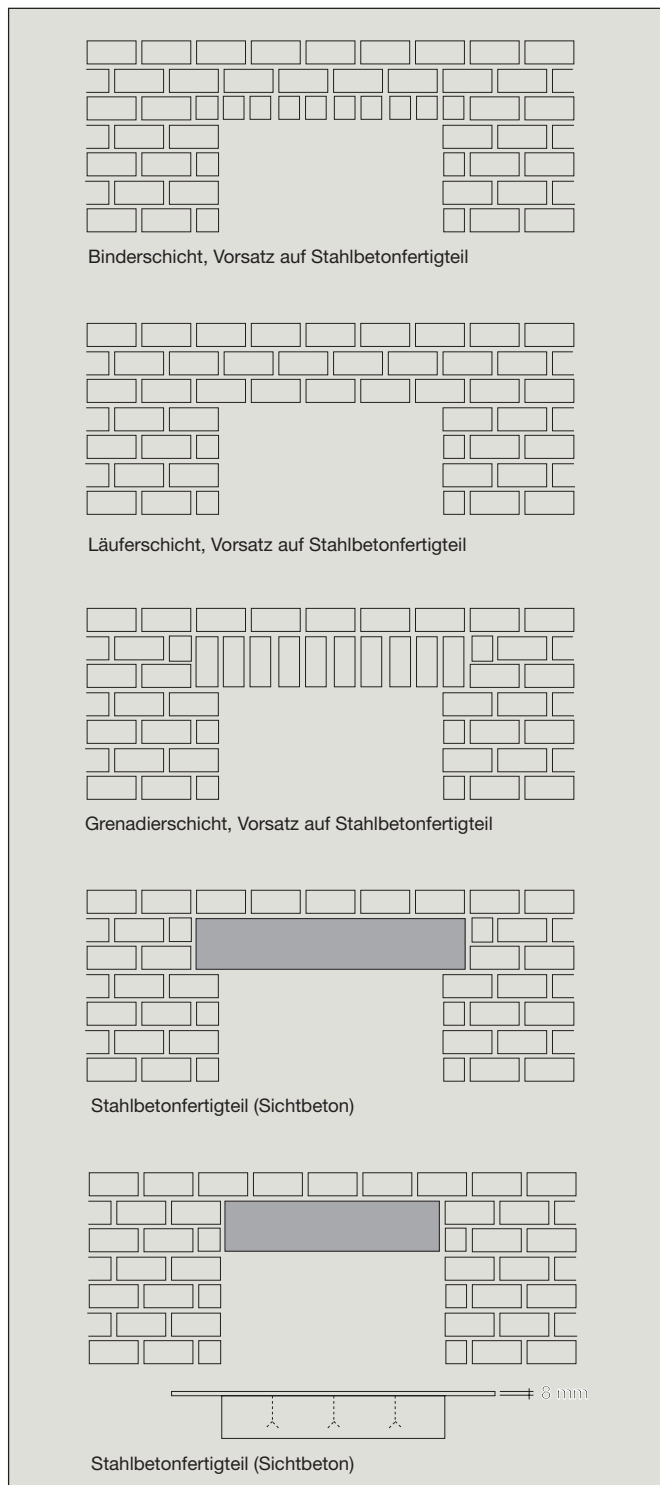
Sturzausbildungen mit Stahlbetonfertigteilen
